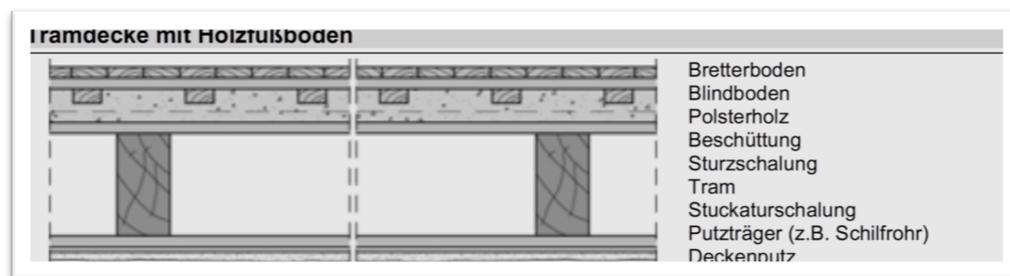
Anton Pech, Bautechnik 2 – Grundlagen
